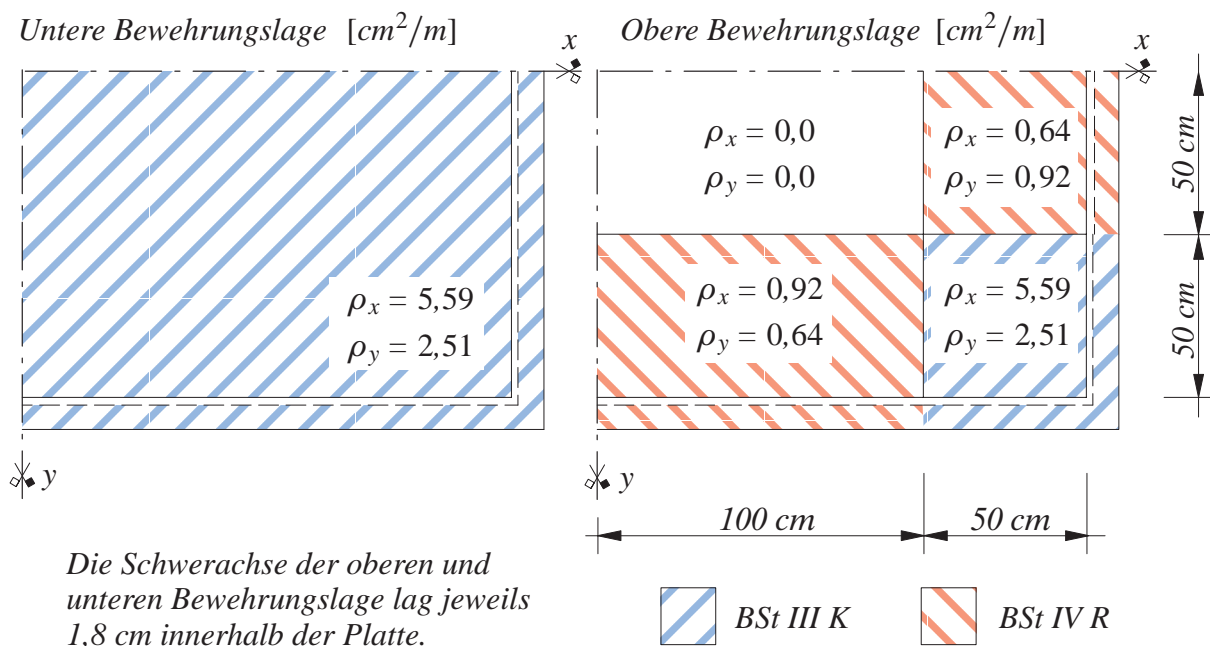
Bewehrungsanordnung (Viertelsystem)
